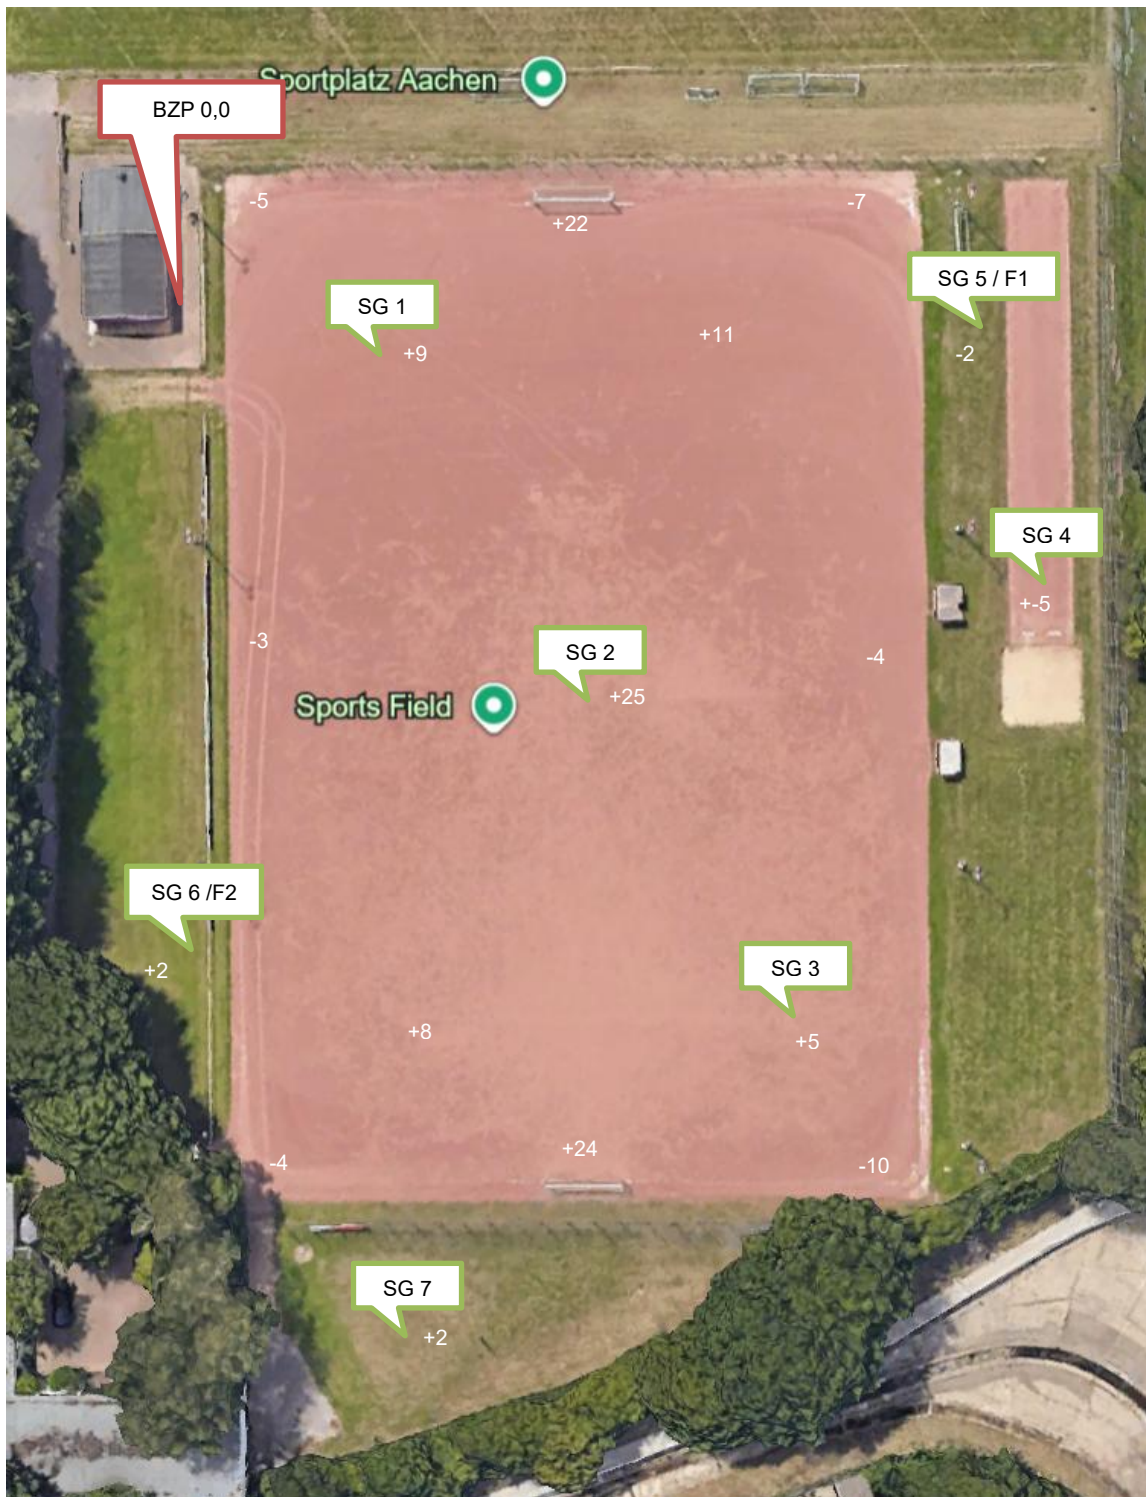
Lageplan (unmaßstäblich) mit Prüfpunkten und Höhenangaben in cm
